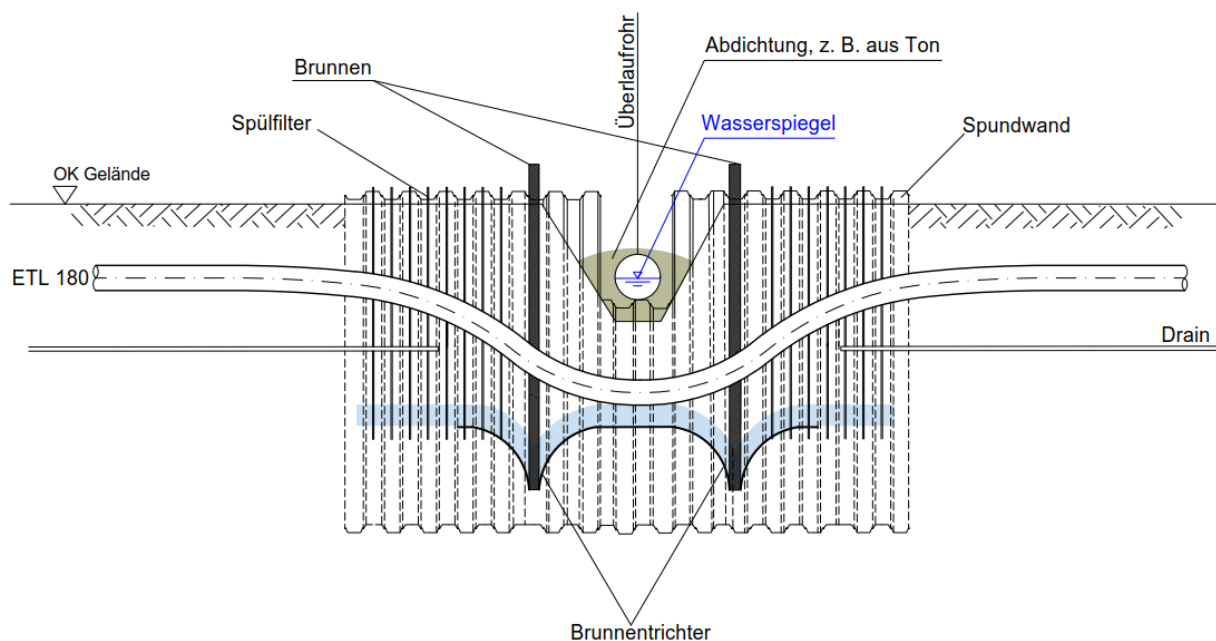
Längsschnitt offene Gewässerkreuzung mit Überlaufrohr (nach Regelplan C09)
